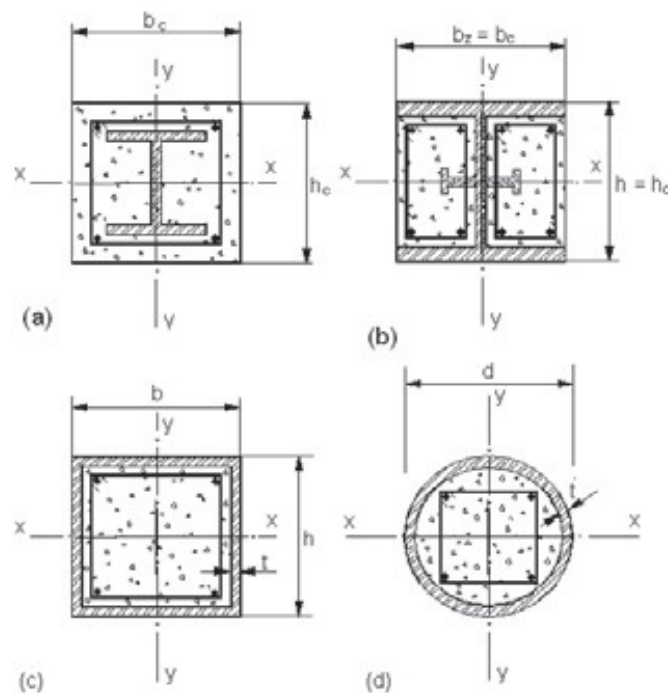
Tipos de seções transversais de pilares mistos. Fonte: NBR-6118
